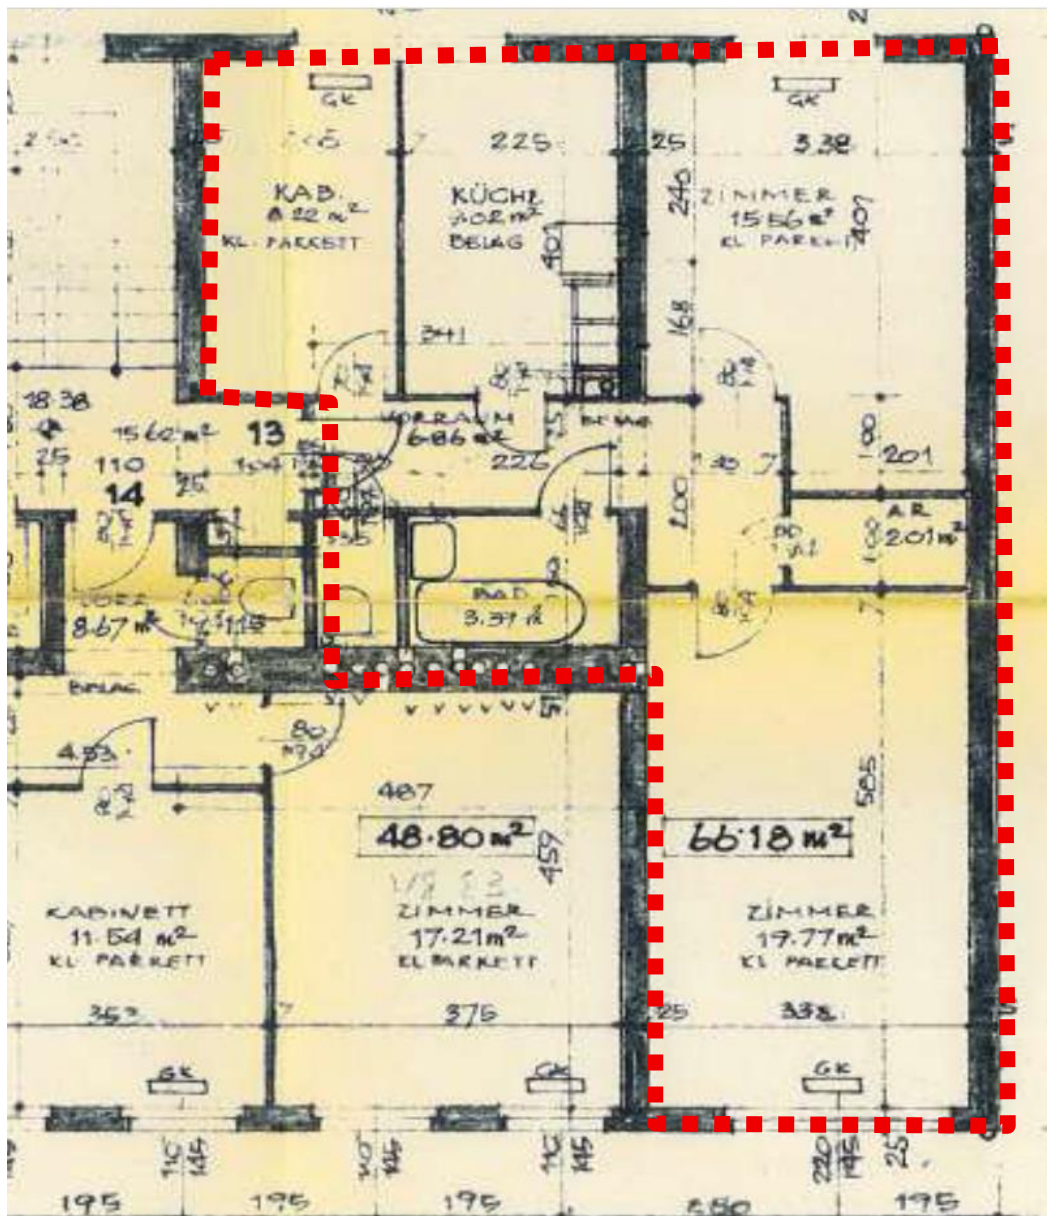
; Grundrissplan Wohnung W4 St I bewertungsgegenständliches Objekt , o.M. Q: Hausverwaltung
